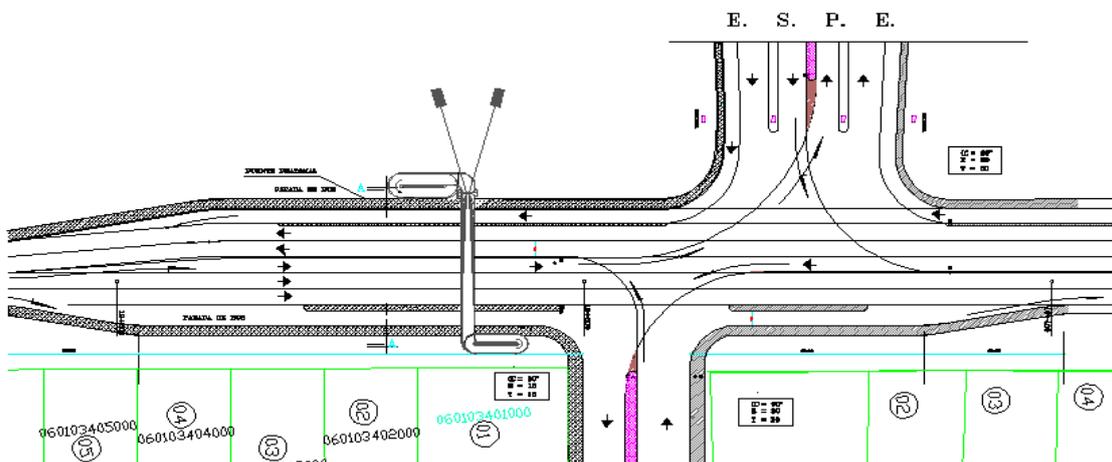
Vista en planta de la ubicación del Puente Peatonal Atirantado
